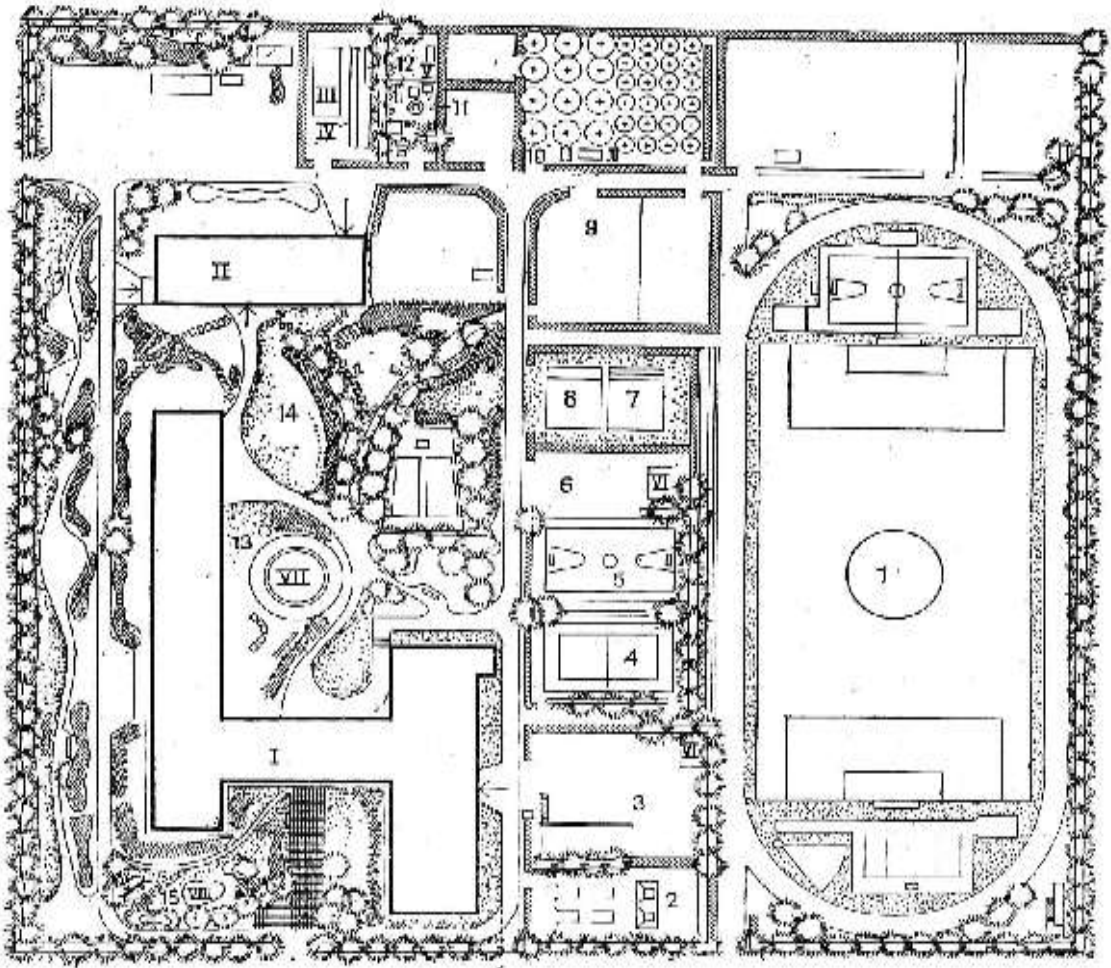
Схема генерального плана общеобразовательной школы на 960 учащихся:
